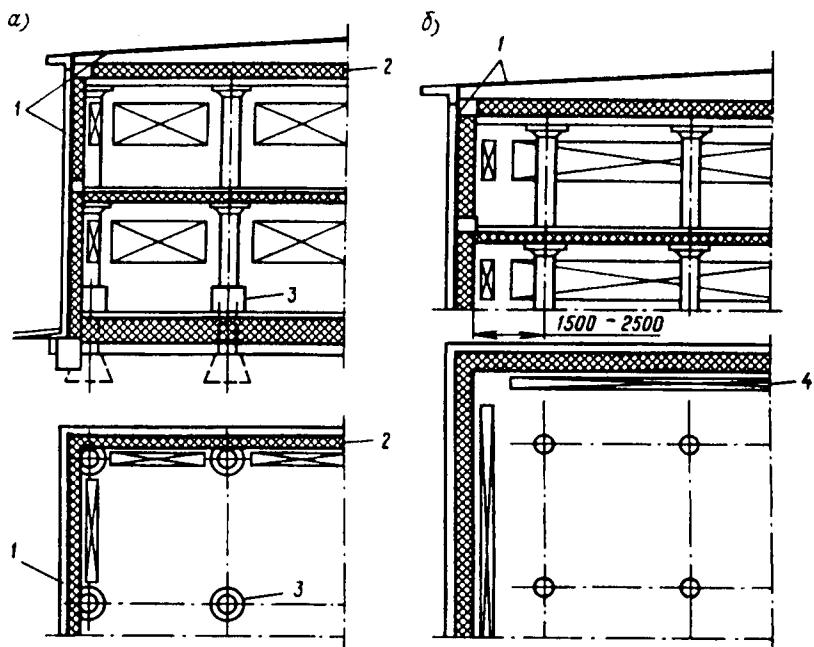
Создание непрерывного изоляционного слоя в этажерочных конструкциях многоэтажных зданий: а — с пристенными колоннами; б — с консольными перекрытиями;
